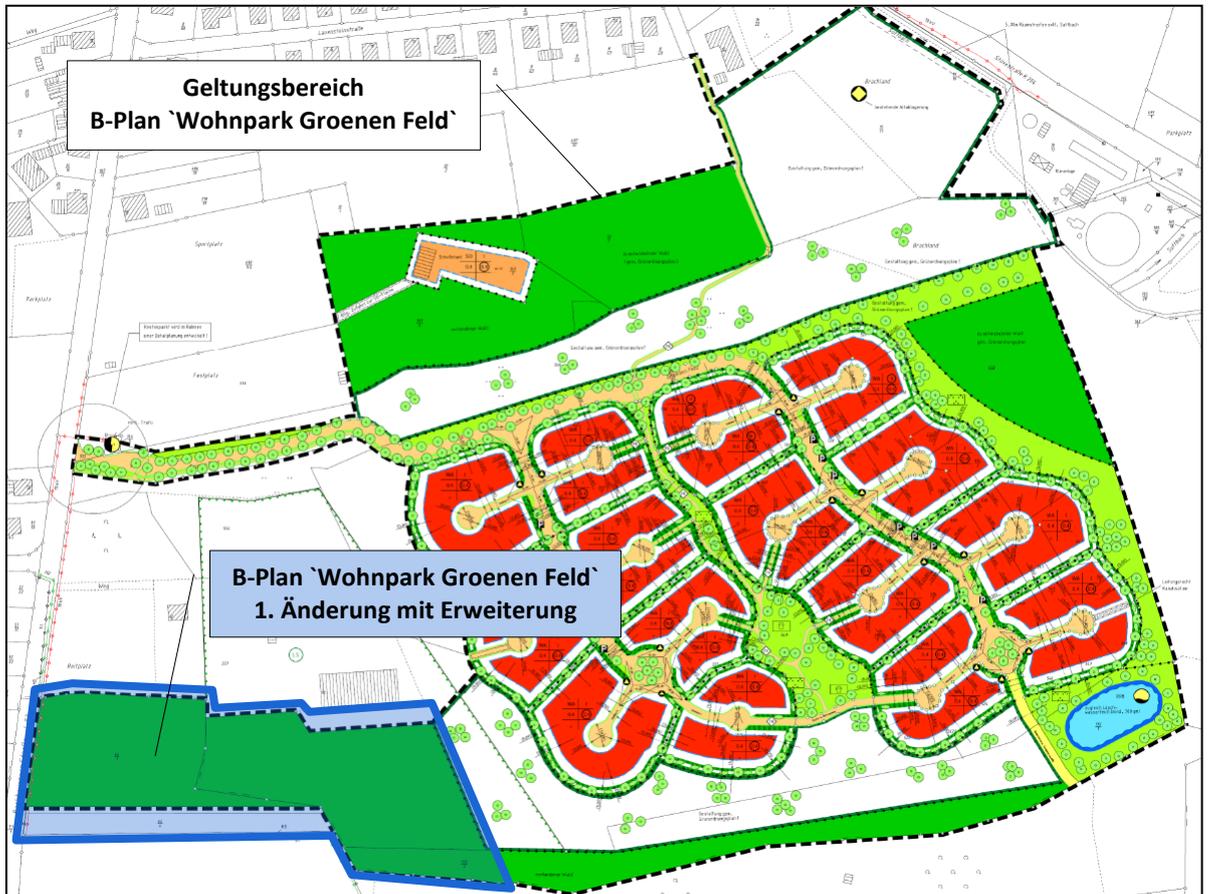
B-Plan 'Wohnpark Groenen Feld' - Luftbildausschnitt 1. Änderung mit Erweiterung (blau); Abgrenzung Kompensationsfläche nach derzeit gültigen B-Plan (grün), ohne Maßstab (Quelle: <http://geoinfo.lkos.de>, abgerufen am 04.08.2019)
